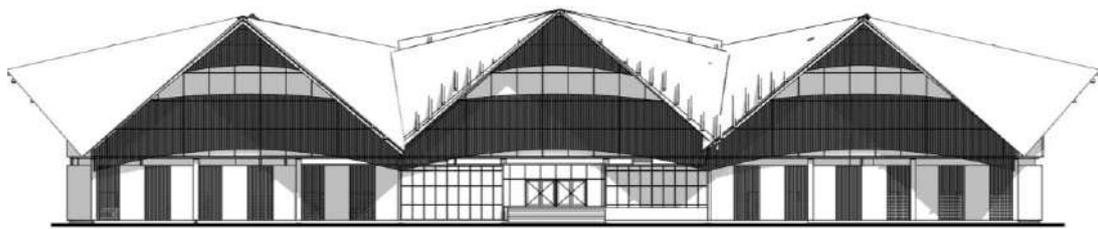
Denah Dome, Kandang sapi, dan Kandang domba
